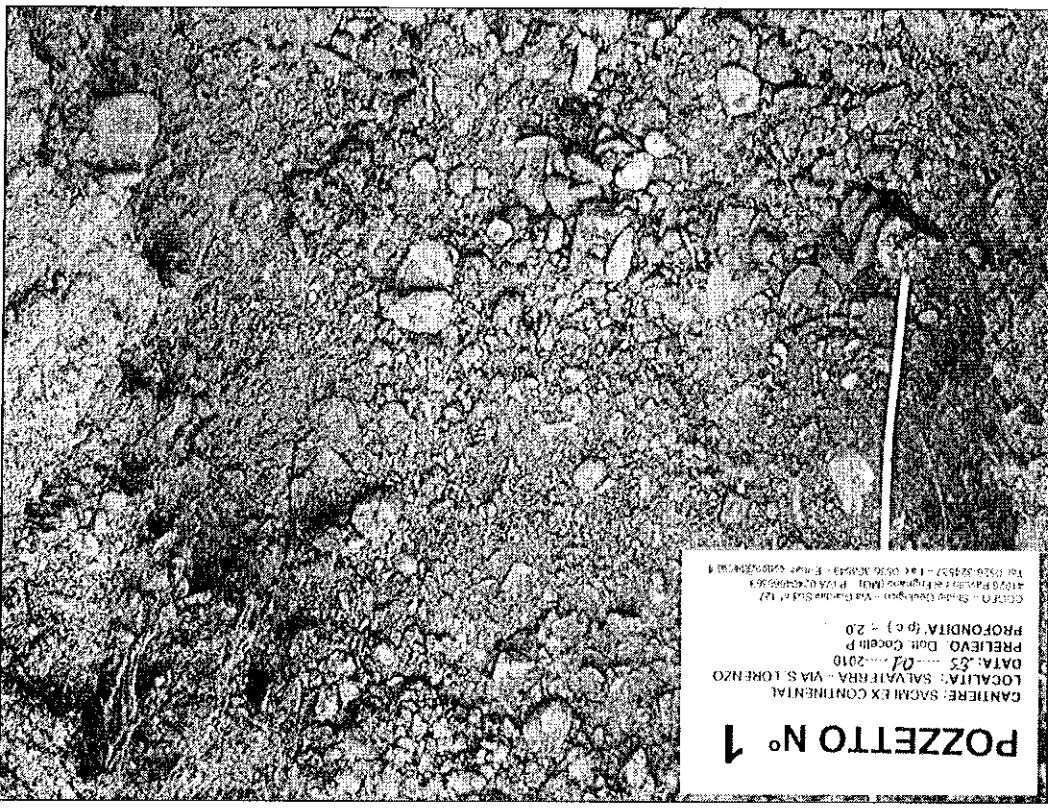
Pozzetto n° 1. Profondità -2.0 m dal p.c.
